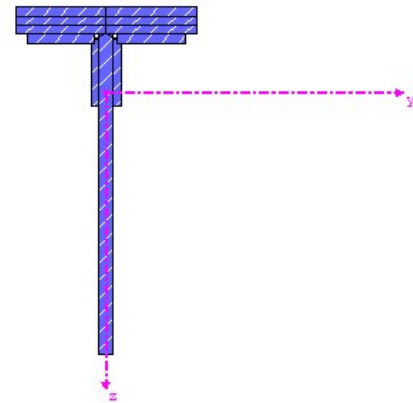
Renderovaný model průřezu – horní pás příhrad č. 3 a 8
